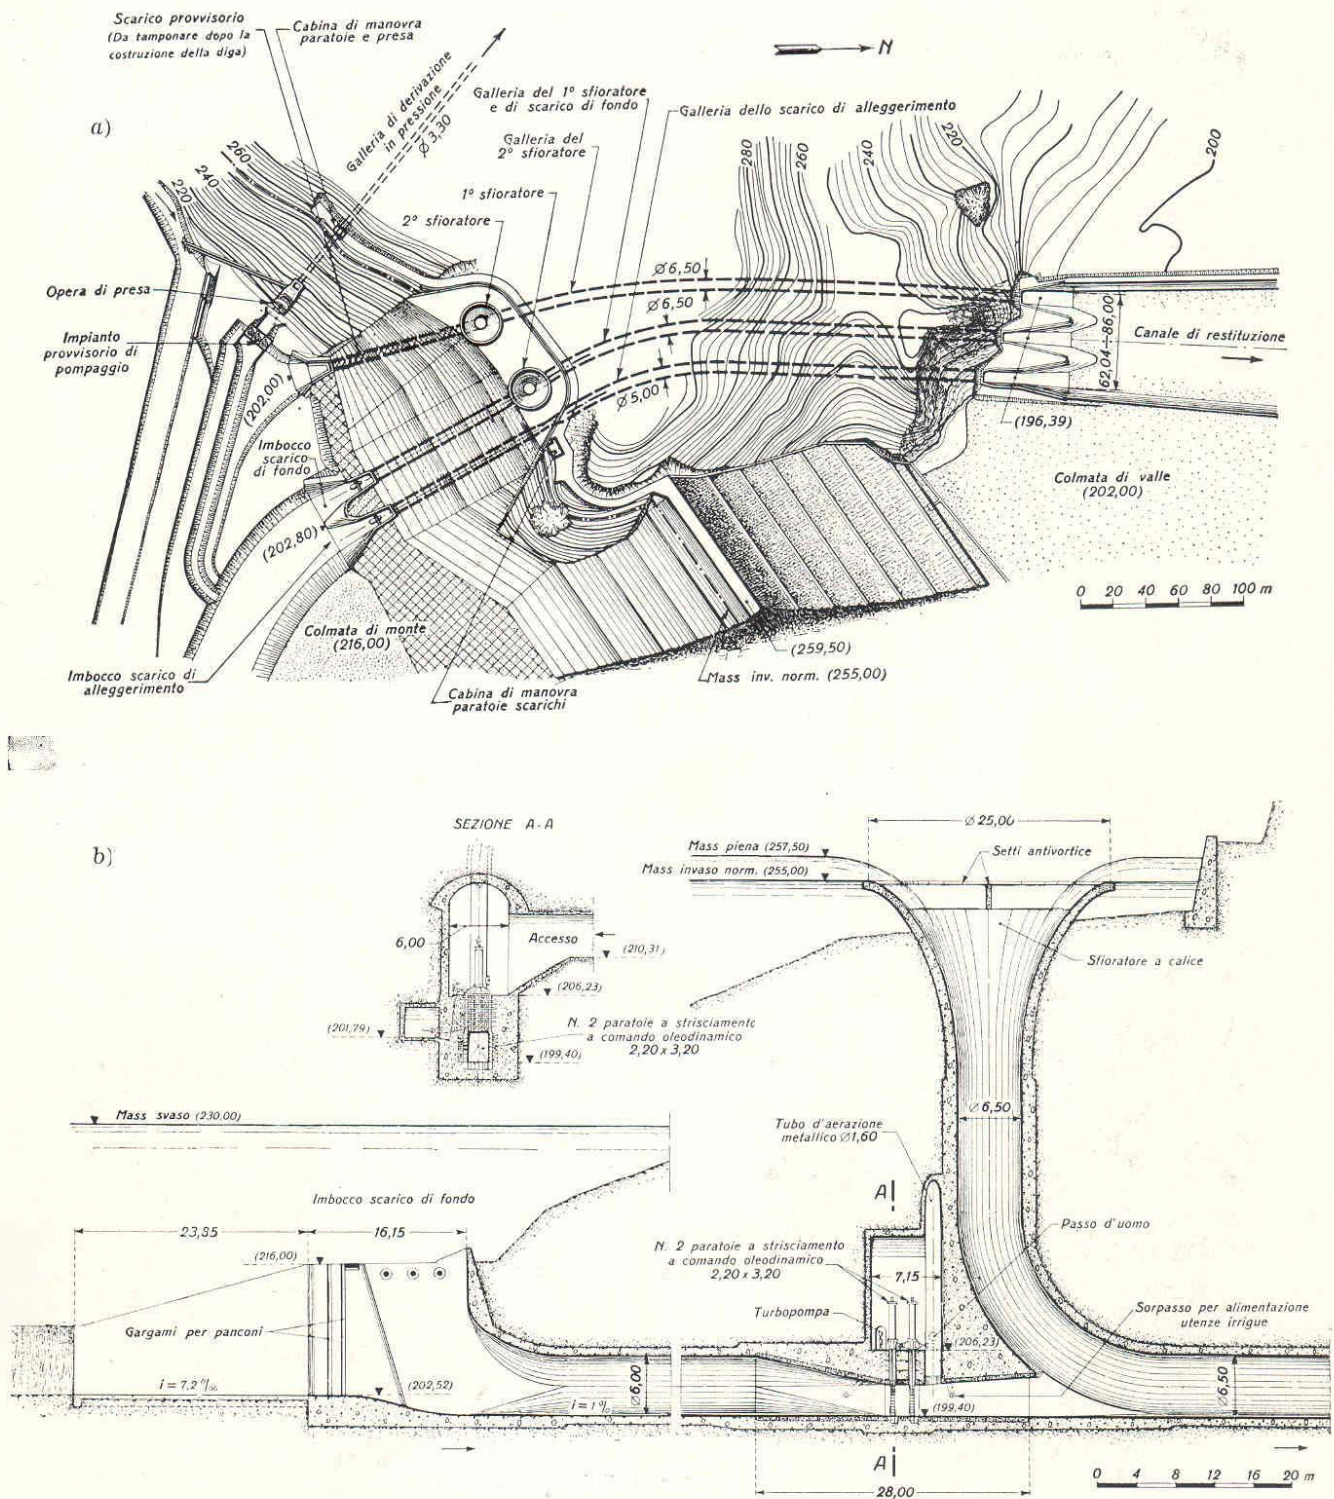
SERBATOIO DI BOMBA — Opere di scarico. a) Planimetria generale - b) Sezione longitudinale dello scarico di fondo e del 1° sfiatore.
